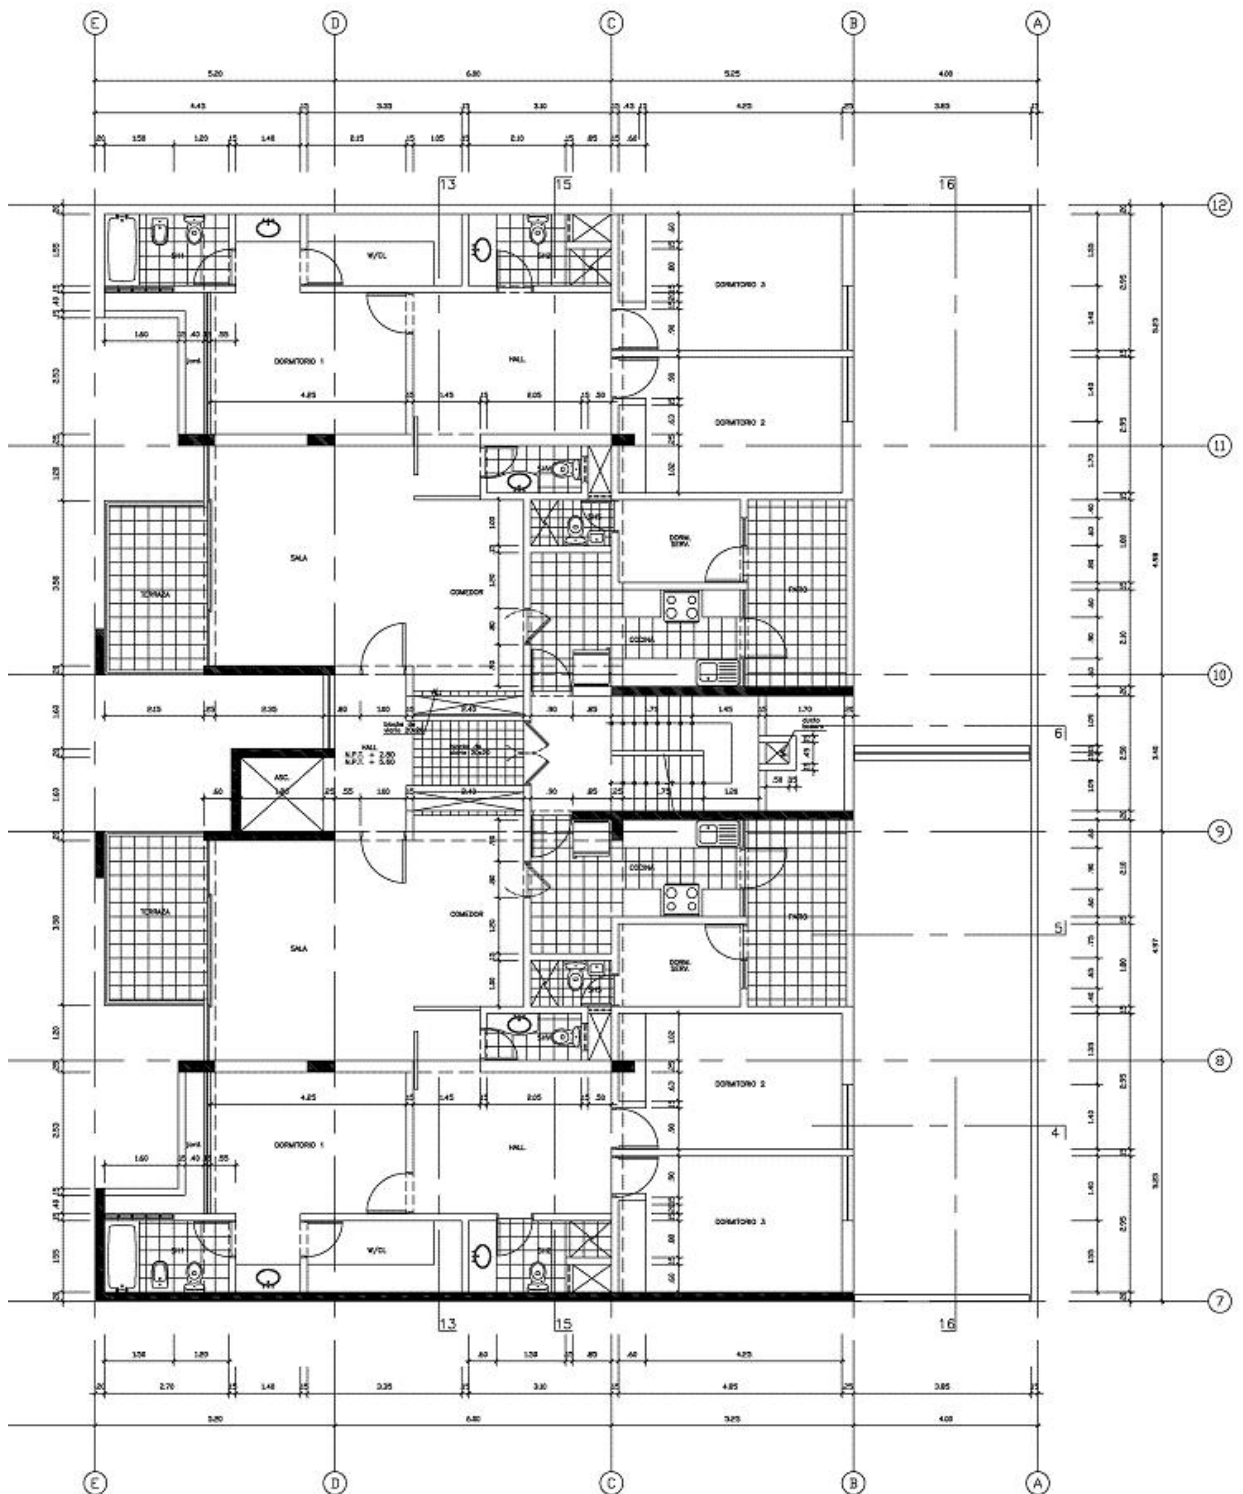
Planta del Edificio de 5 pisos con sótano Bloque B
